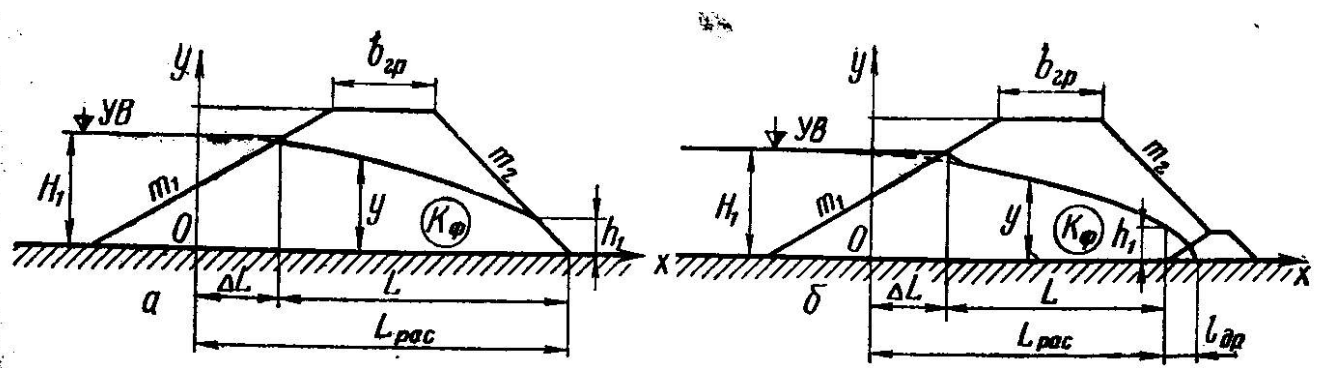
Схемы к фильтрационным расчетам:
